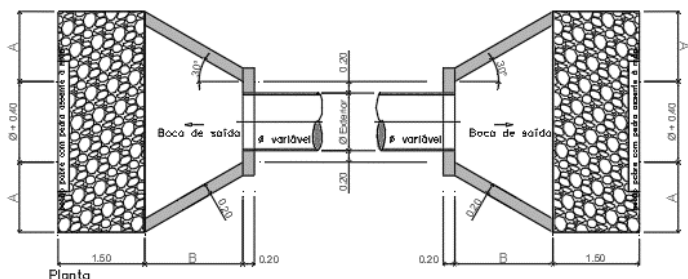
Planta de passagem hidráulica simples de secção circular (IEP, 2001)
